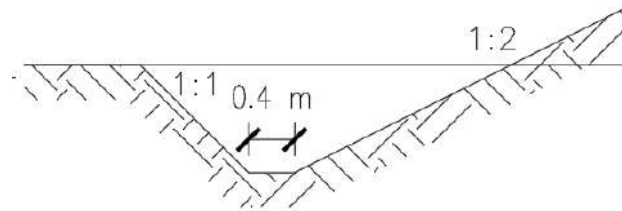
Croquis cuneta tipo. Fuente: Elaboración propia.
